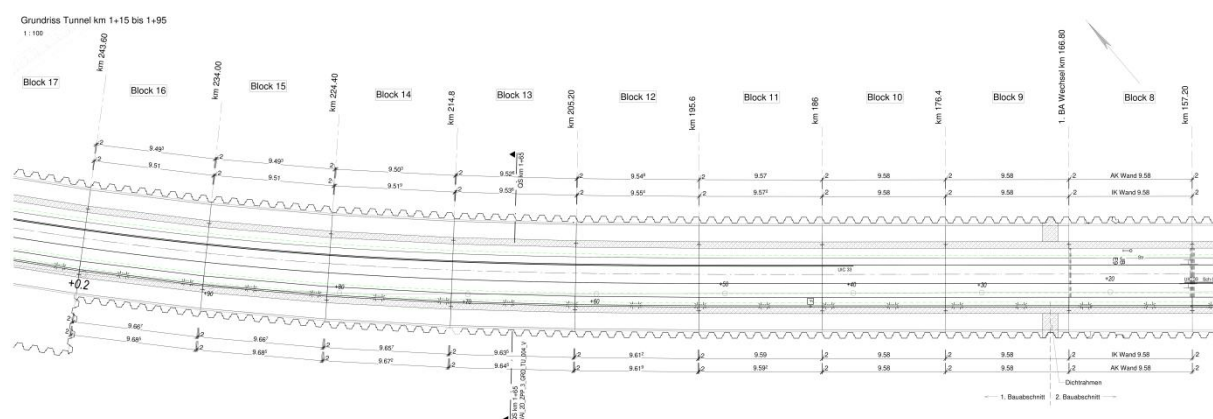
Grundriss Ersatzneubau km 1+15 bis 1+95
